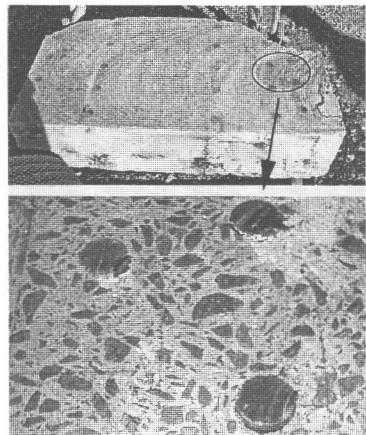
切断面と鉄筋周囲の状態(一般水中コン)
